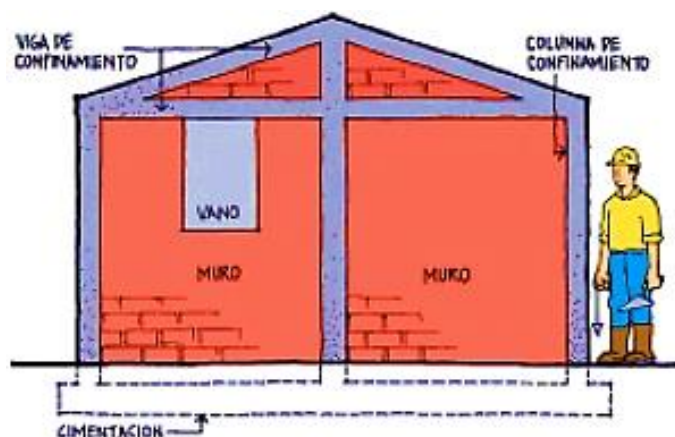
Elementos de Confinamiento (Vigas – Columnas).
